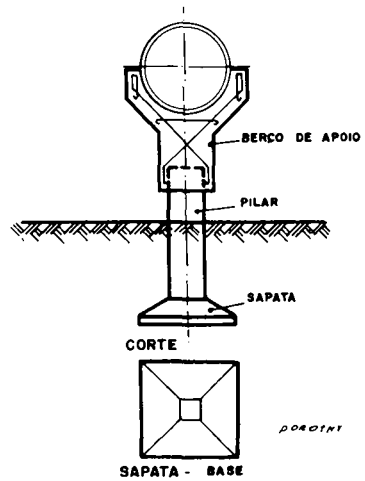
BERÇO DE APOIO DO PILAR (20*)
